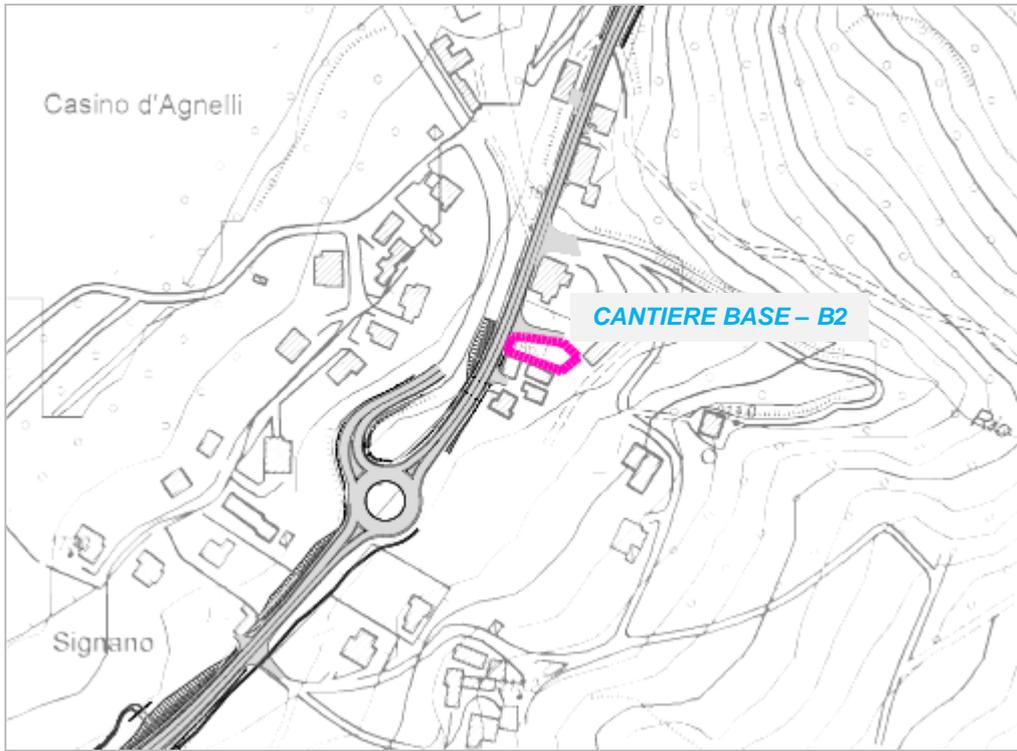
PLANIMETRIA CANTIERE BASE B2
